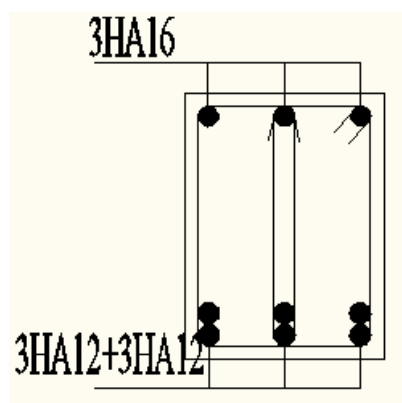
Ferrailage sur appuis d'une poutre principale.
